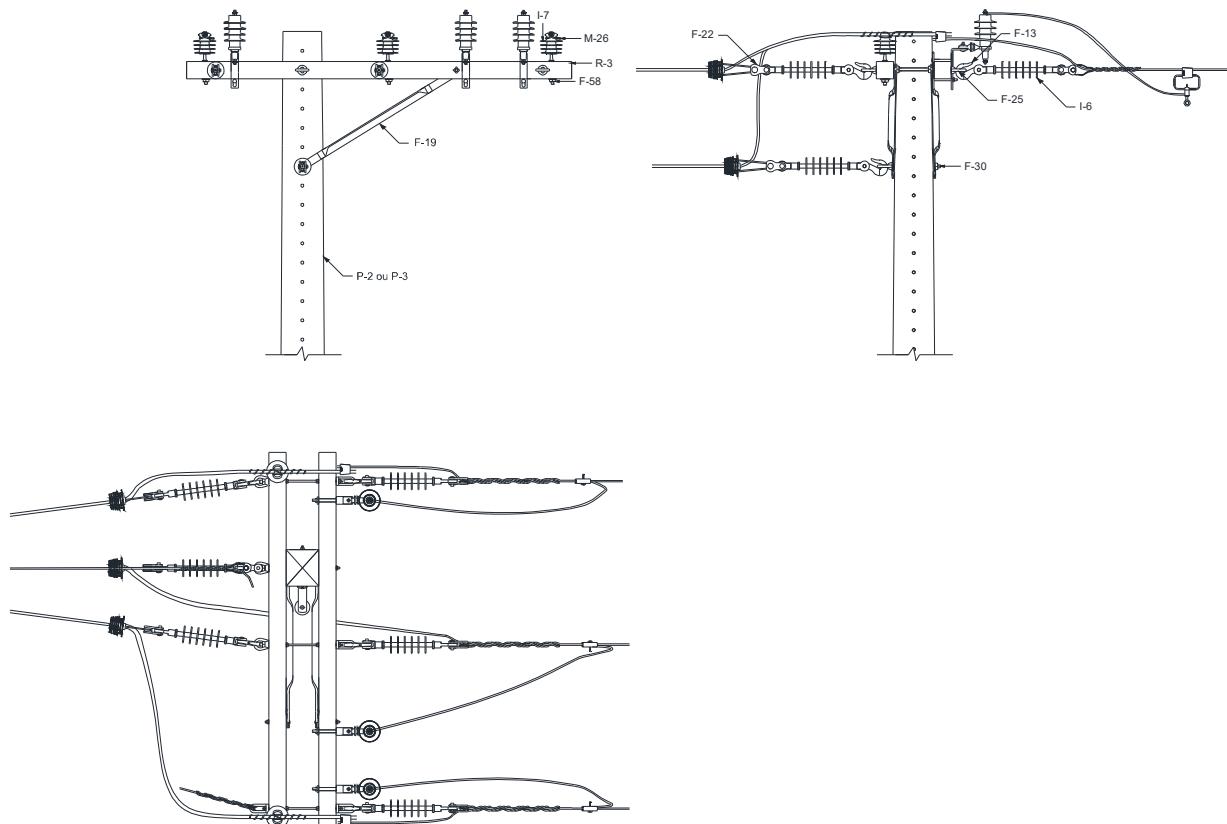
Estruturas especiais – Estrutura M3-C3A
